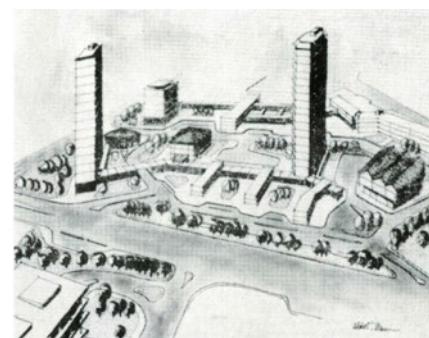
Prospettiva a volo d'uccello del Centro direzionale, dal progetto del *piano degli ingegneri*, disegno dell'architetto Aldo Villani.
